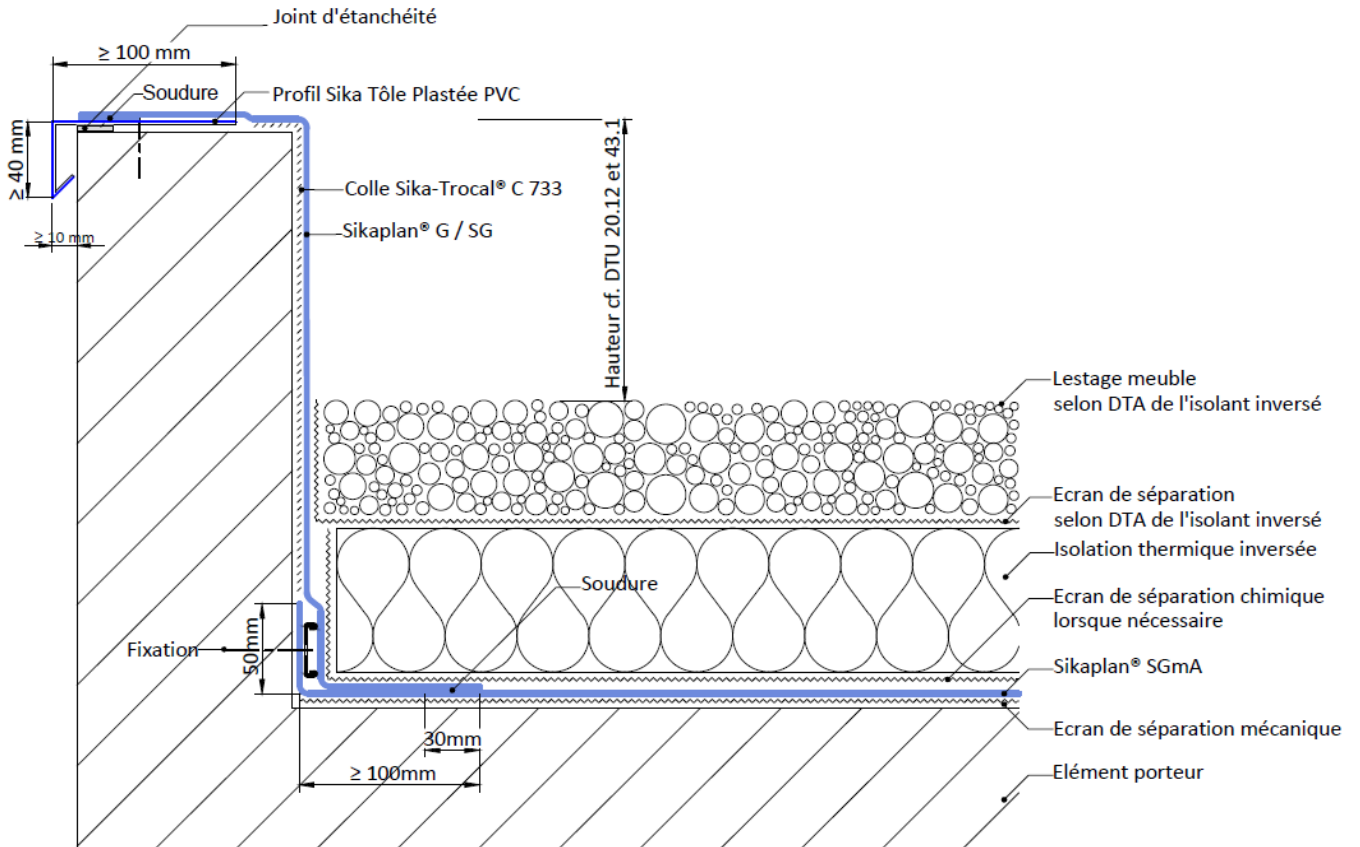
Relevé d'étanchéité avec profil de rive Sika Tôle Plastée PVC – Travaux neufs sur maçonnerie avec isolation inversée
